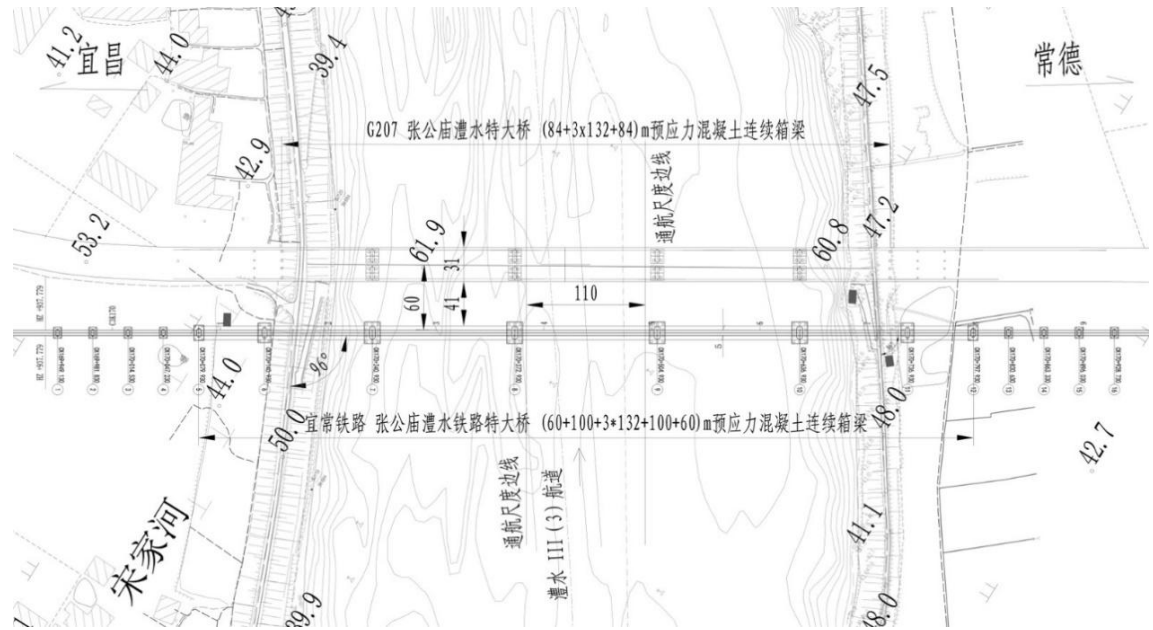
并行张公庙公路大桥方案跨越澧桥址平面图
